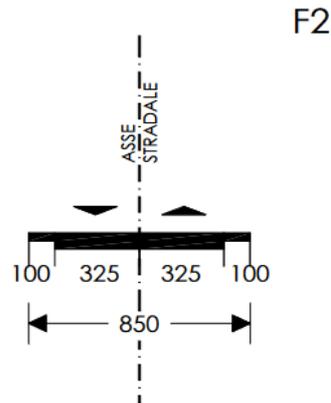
Sezione tipo F2 – Locale extraurbana
